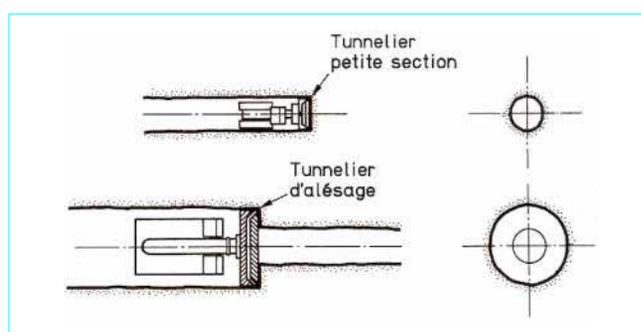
Excavation au tunnelier par galerie pilote et alésage
